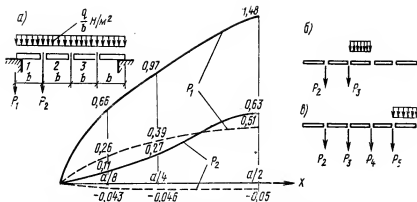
Схема загрузки и опирания сборных перекрытий
